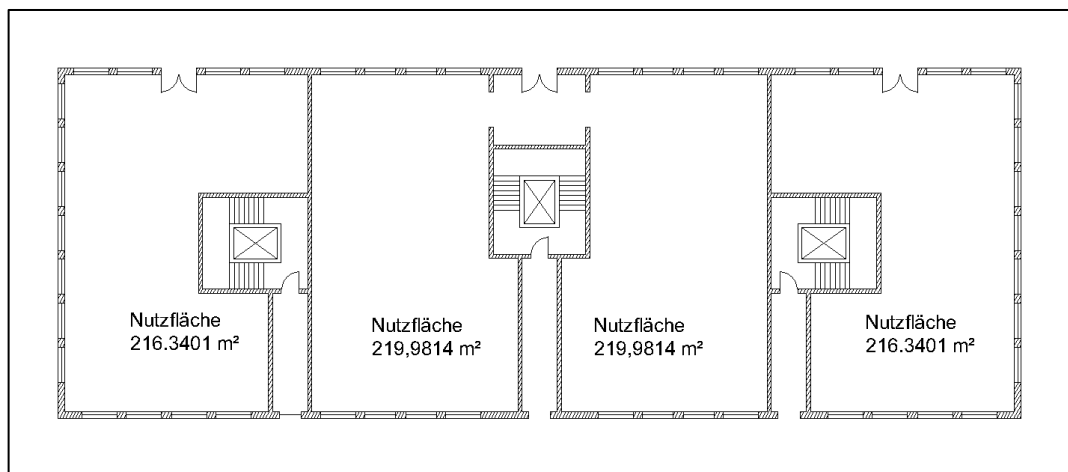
Grundriss Erdgeschoss Mischgebäude (ohne Maßstab)
